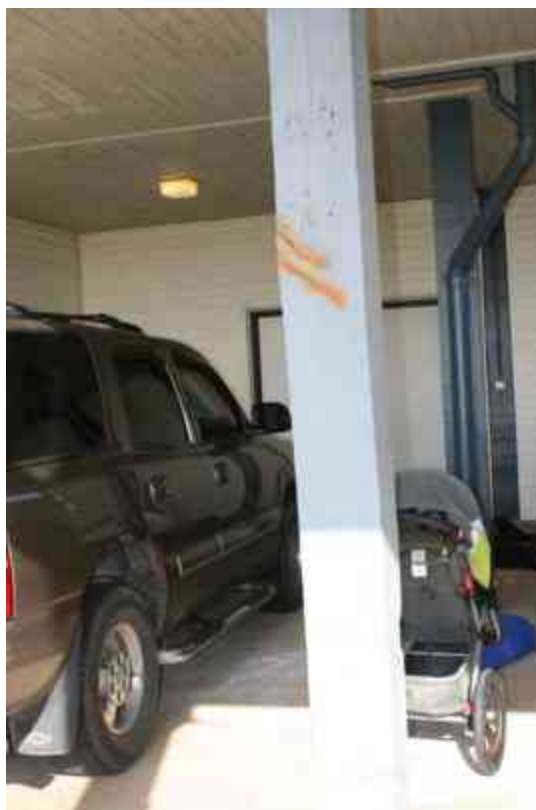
Pilar fallo por nudo (acercamiento). Autor: JAPG.
